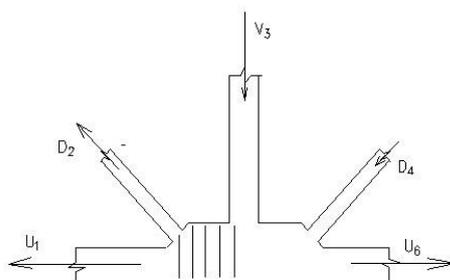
схема к расчету узла Знижнего пояса
